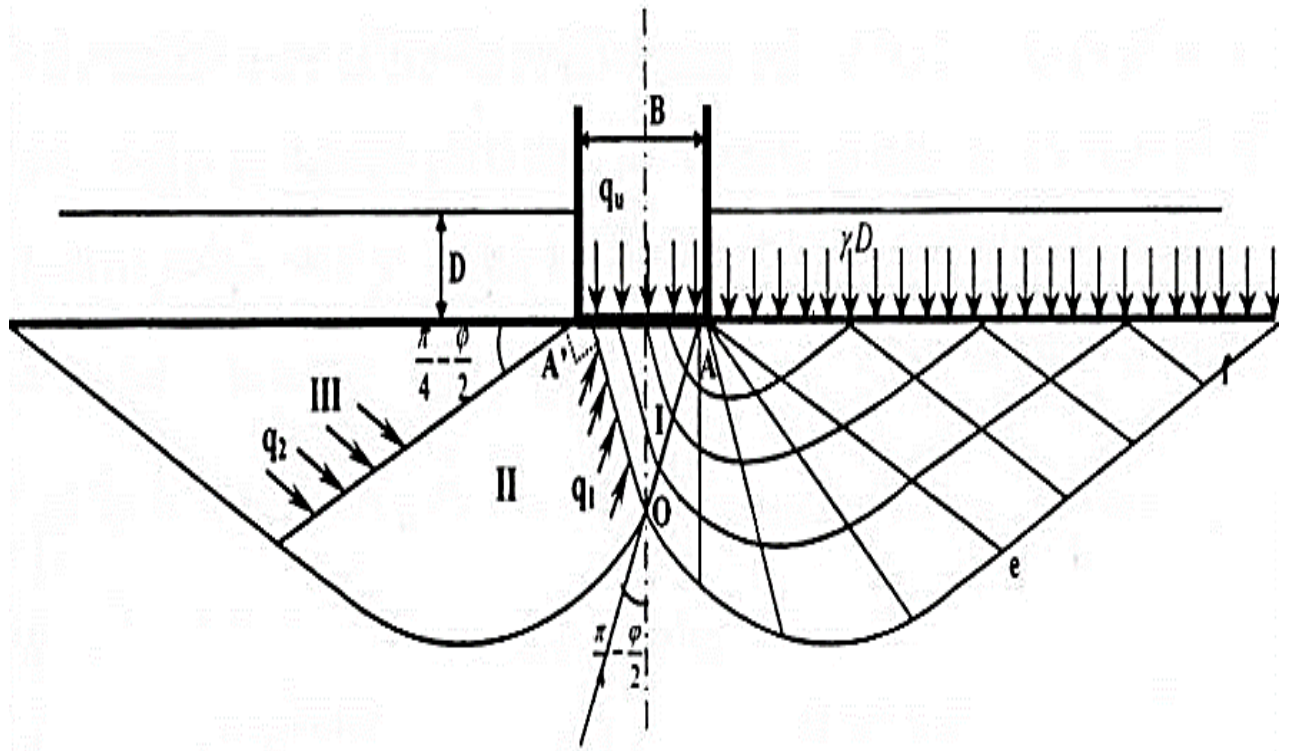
Mécanisme de rupture d'une fondation de base lisse [Prandtl (1920)]
